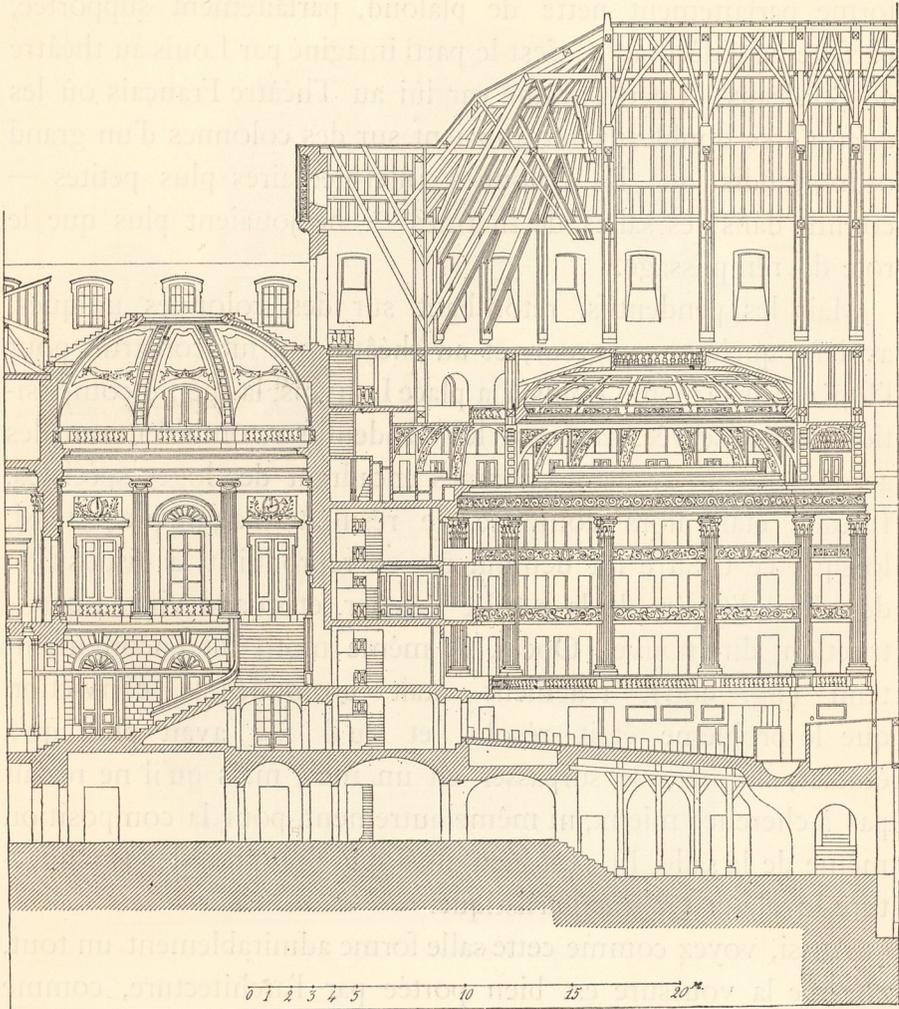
Coupe longitudinale de la salle du grand Théâtre de Bordeaux.
